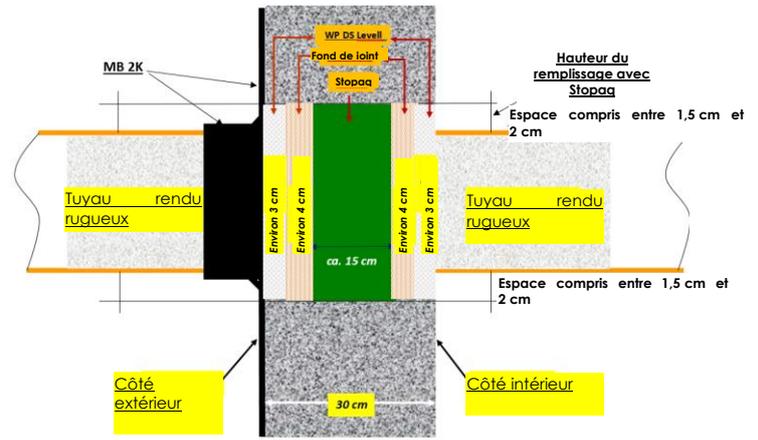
détail de l'étanchéité à l'eau de la traversée de tuyau - étanchéité autour du tuyau
